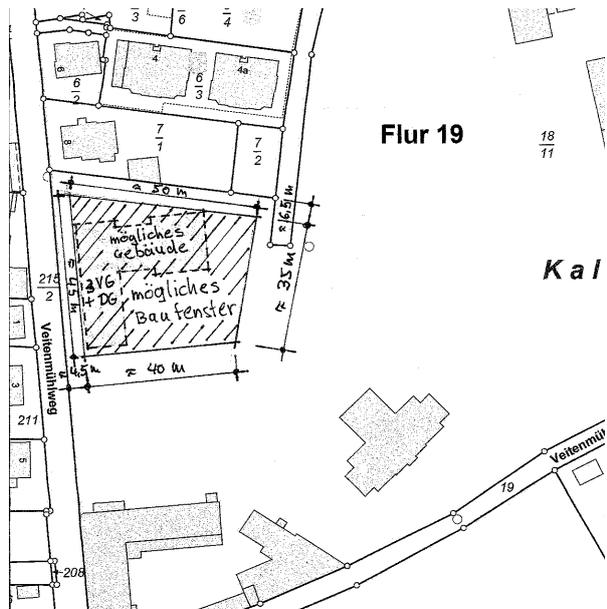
„Ausschnitt -Lageplan aus der Bauvoranfrage vom 09.07.2010“
